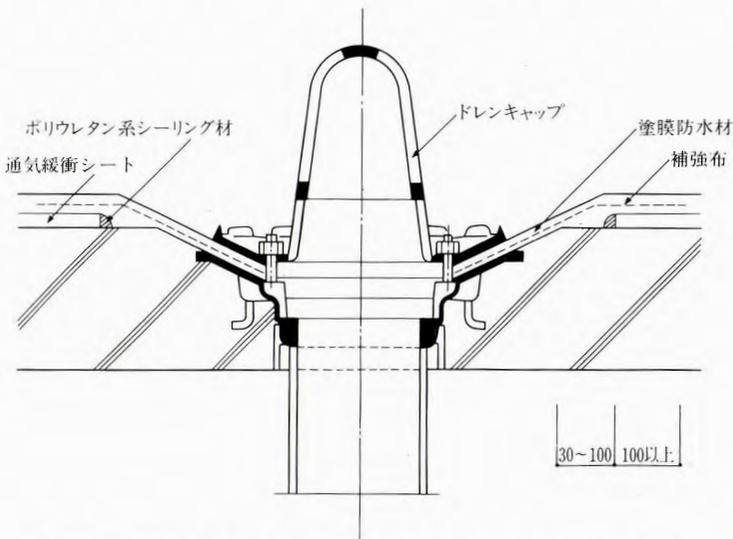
補強布と通気緩衝シートの取合い(ドレン回り)(単位: mm)
